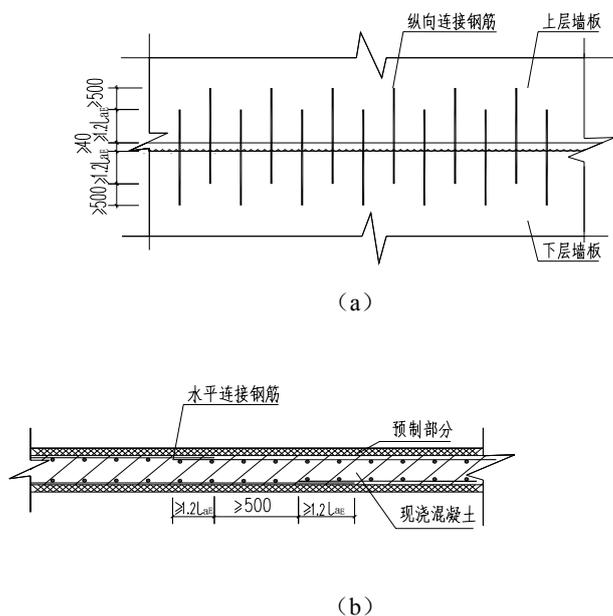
叠合板式剪力墙结构墙板连接钢筋搭接构造
